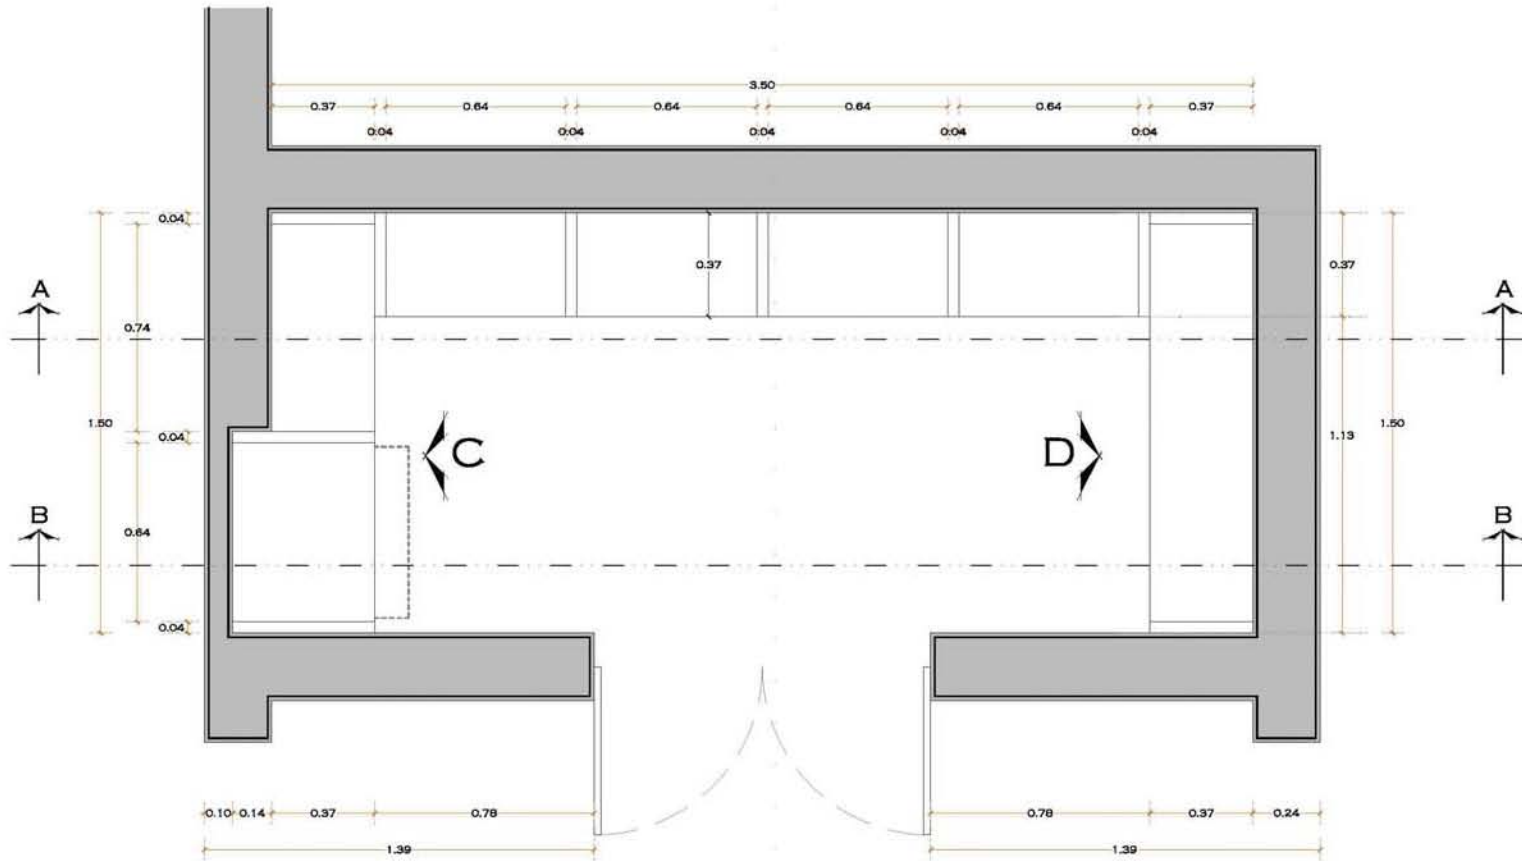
MUEBLE DE BAÑO EN RECÁMARA 2.
